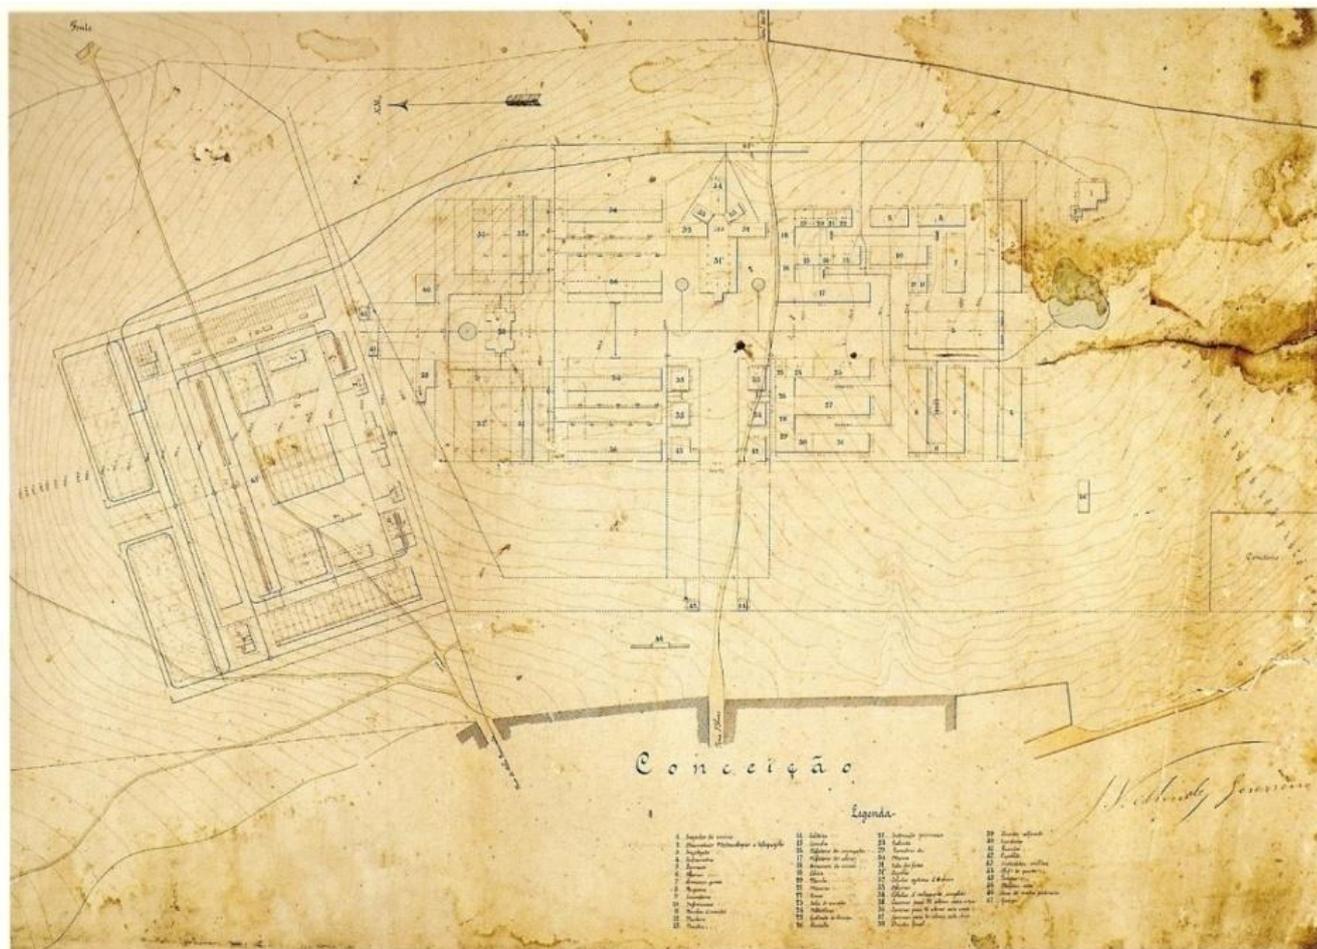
Escola Agrícola de Reforma. Planta geral do Eng.J.V. Mendes Guerreiro (1881)
